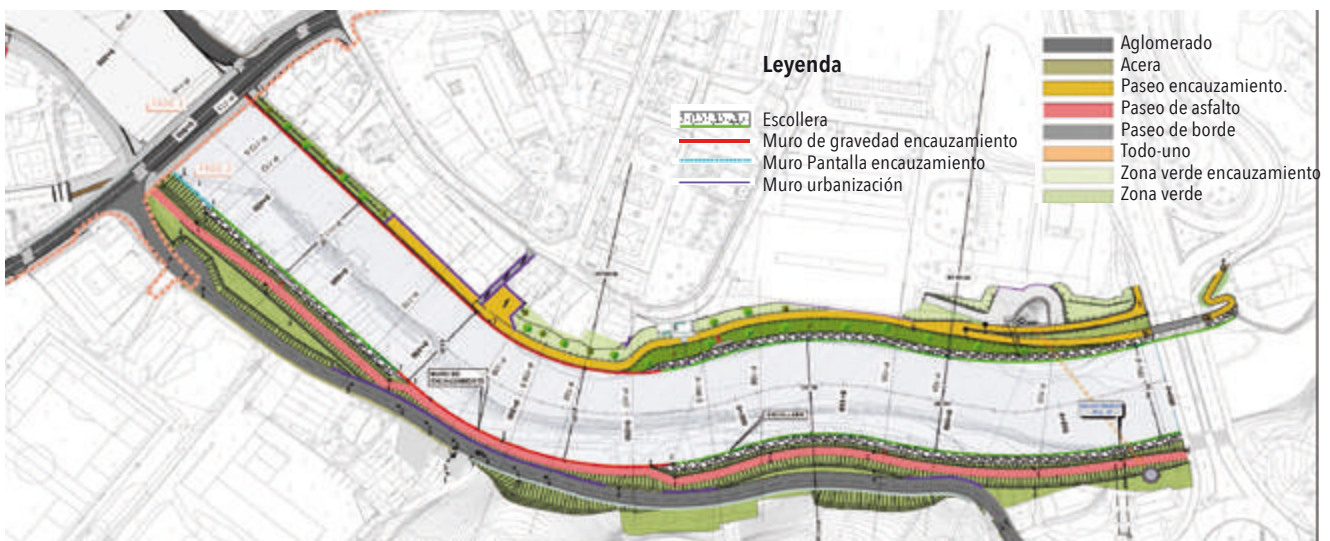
Planta proyecto FASE 2. Fuente: URA (2017)
